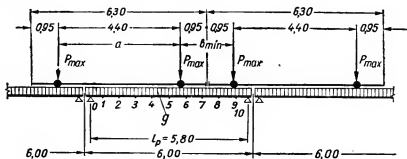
Расчетная схема балки и схема вертикальных нагрузок.
